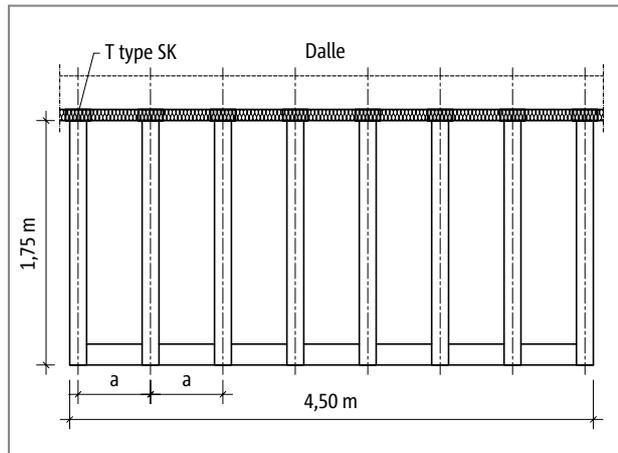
Schöck Isokorb® T type SK : Plan de base
